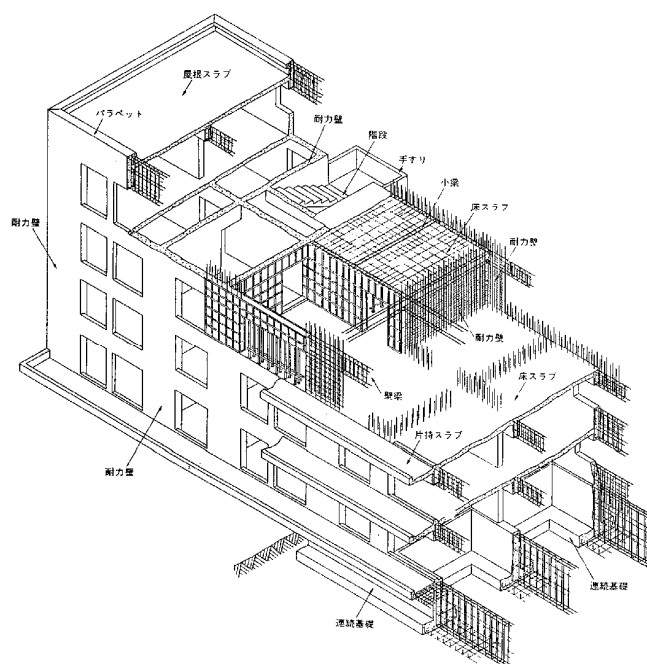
鉄筋コンクリート造（壁式構造）の構成¹⁰⁶⁾
